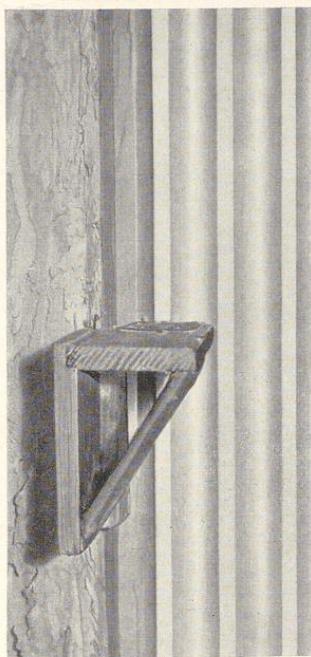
Schablone zum Ziehen der Stege an geschwelter Säule
